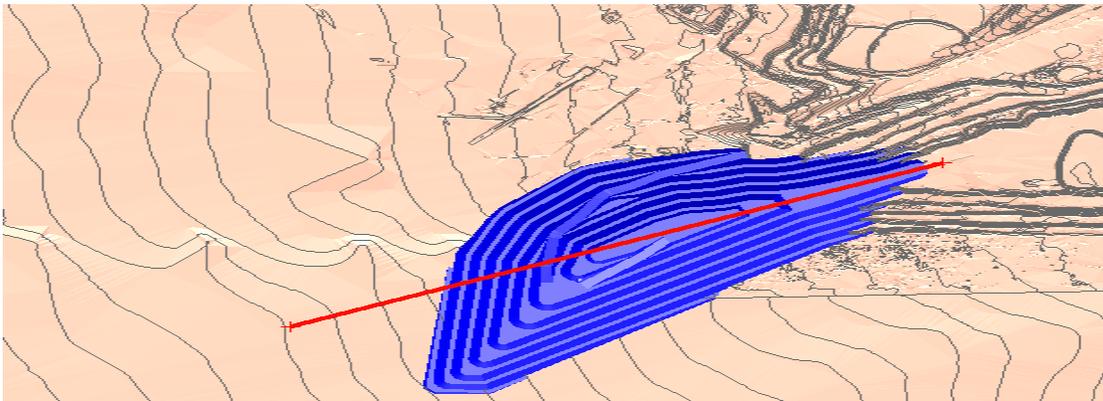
Vista en planta y corte longitudinal de Tepetatera Suroeste
